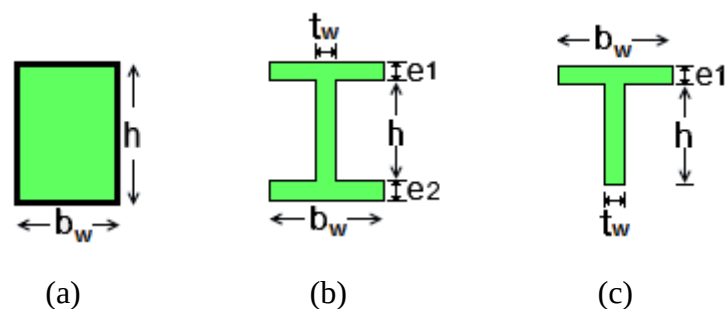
Seção transversal (a) retangular, (b) Perfil I e (c) Perfil T.
